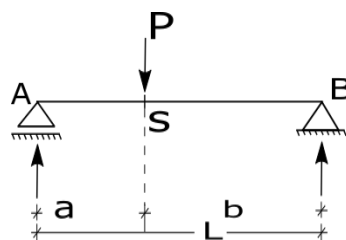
Viga simplesmente apoiada. (Melo, 2016 d).
